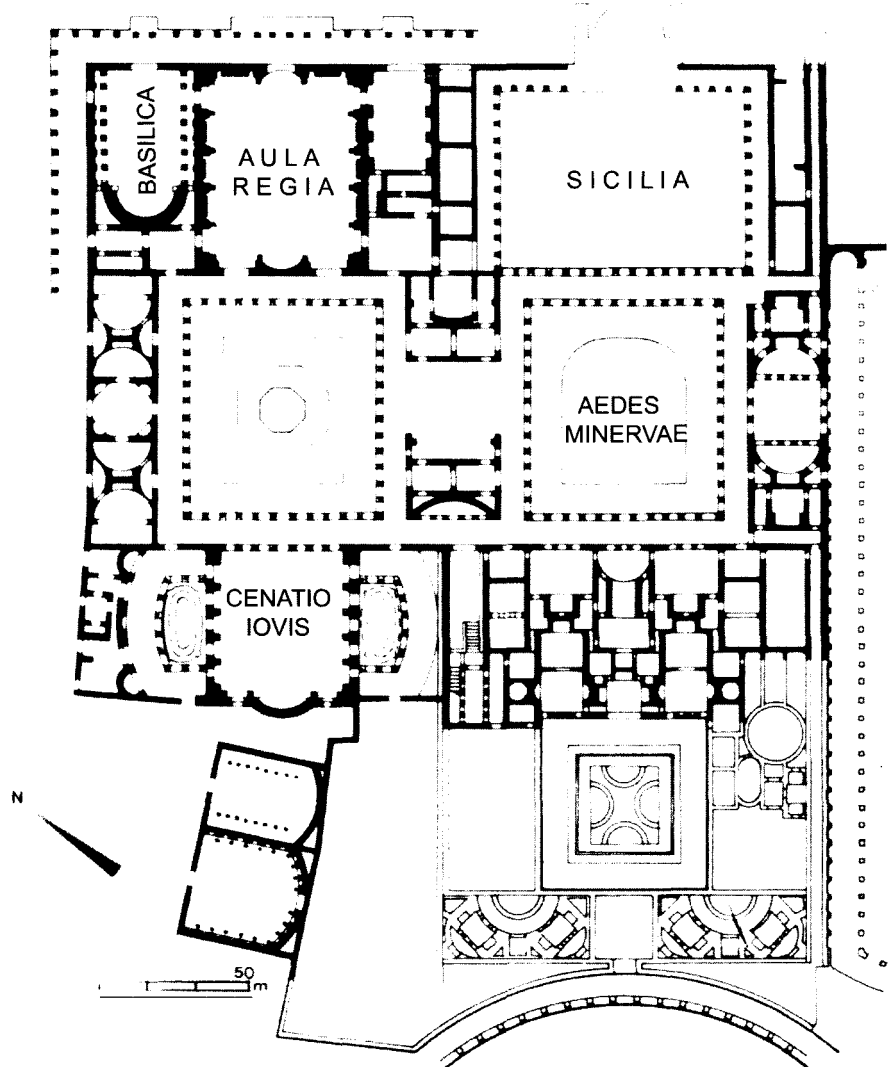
Planimetria del Palazzo dei Flavi sul Palatino,
